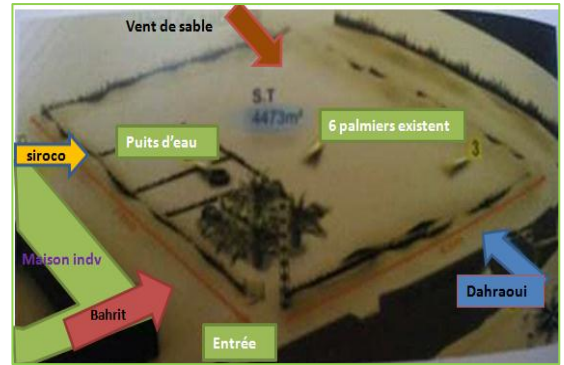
Plan de masse. Source : revue vies de ville N°22
